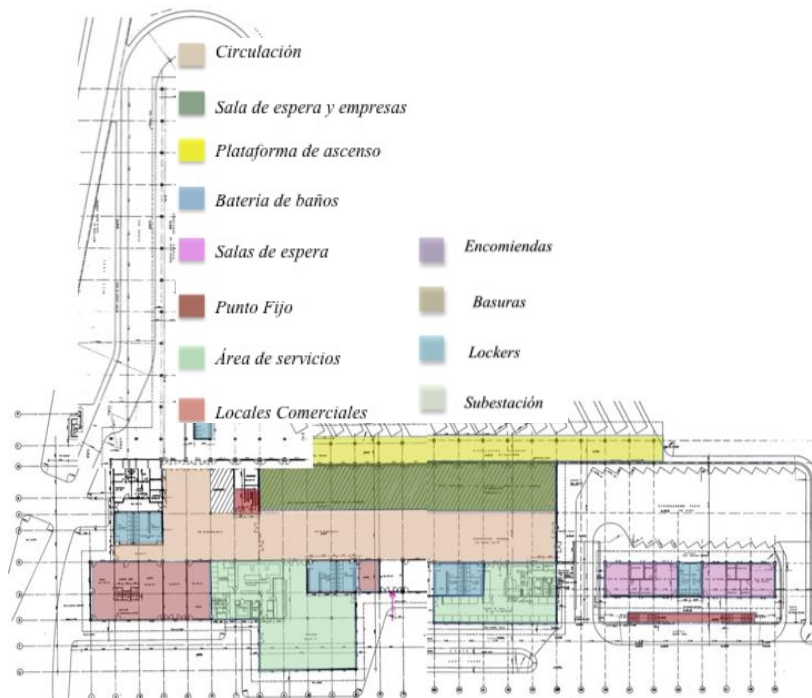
Análisis Zonificación proyecto Girardot. Adaptado de Plano Revista Escala 63.
